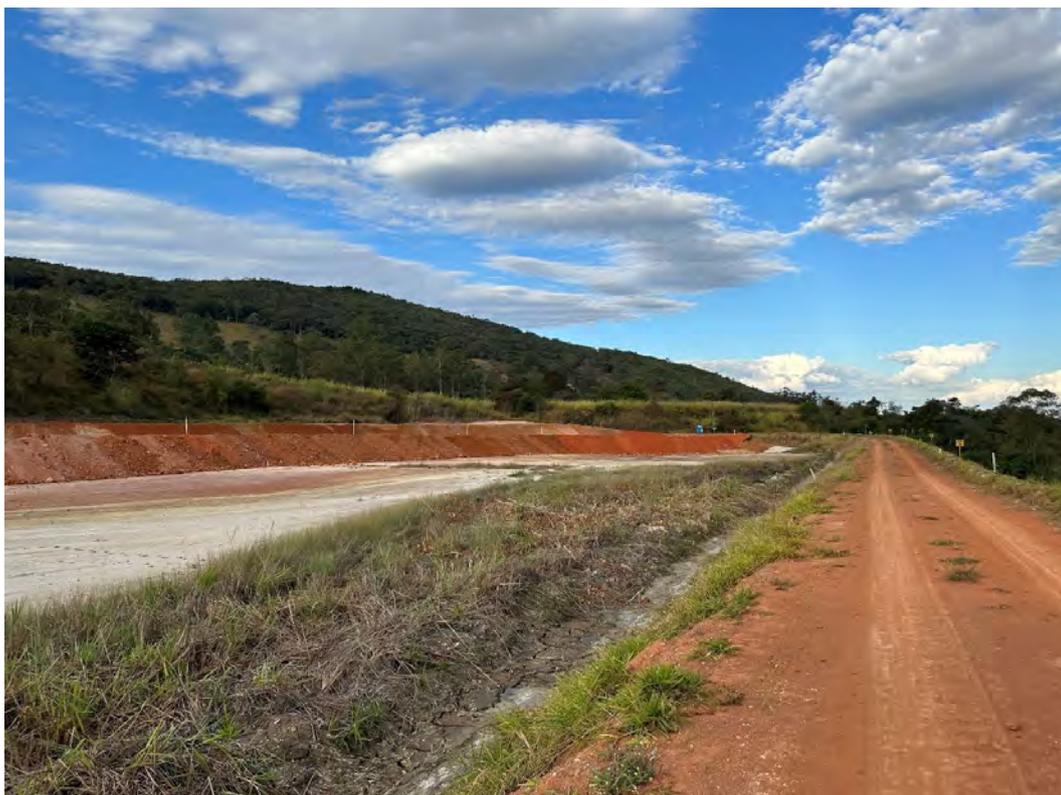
Crista da barragem – Vista para a ombreira direita.
